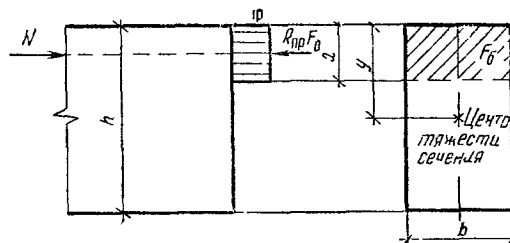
Схема усилий и эпюра напряжений в сечении, нормальном к продольной оси внецентренно-сжатого бетонного элемента, рассчитываемого без учета сопротивления бетона растянутой зоны
